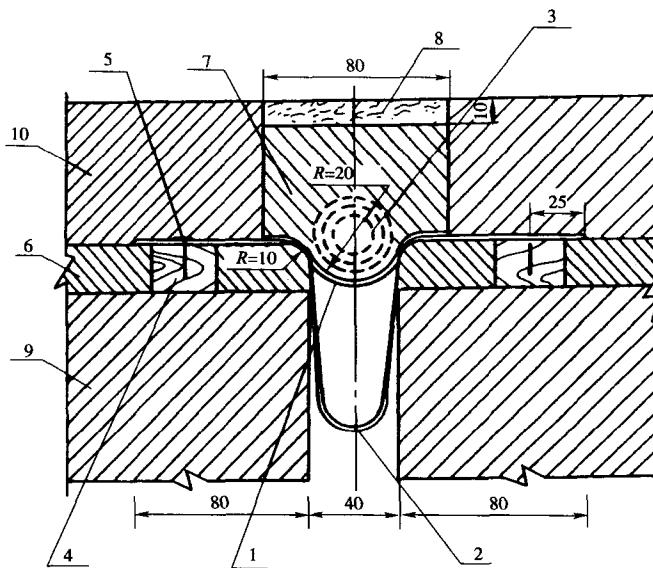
“U”形镀锌铁皮伸缩装置构造示意图(尺寸单位:mm)
